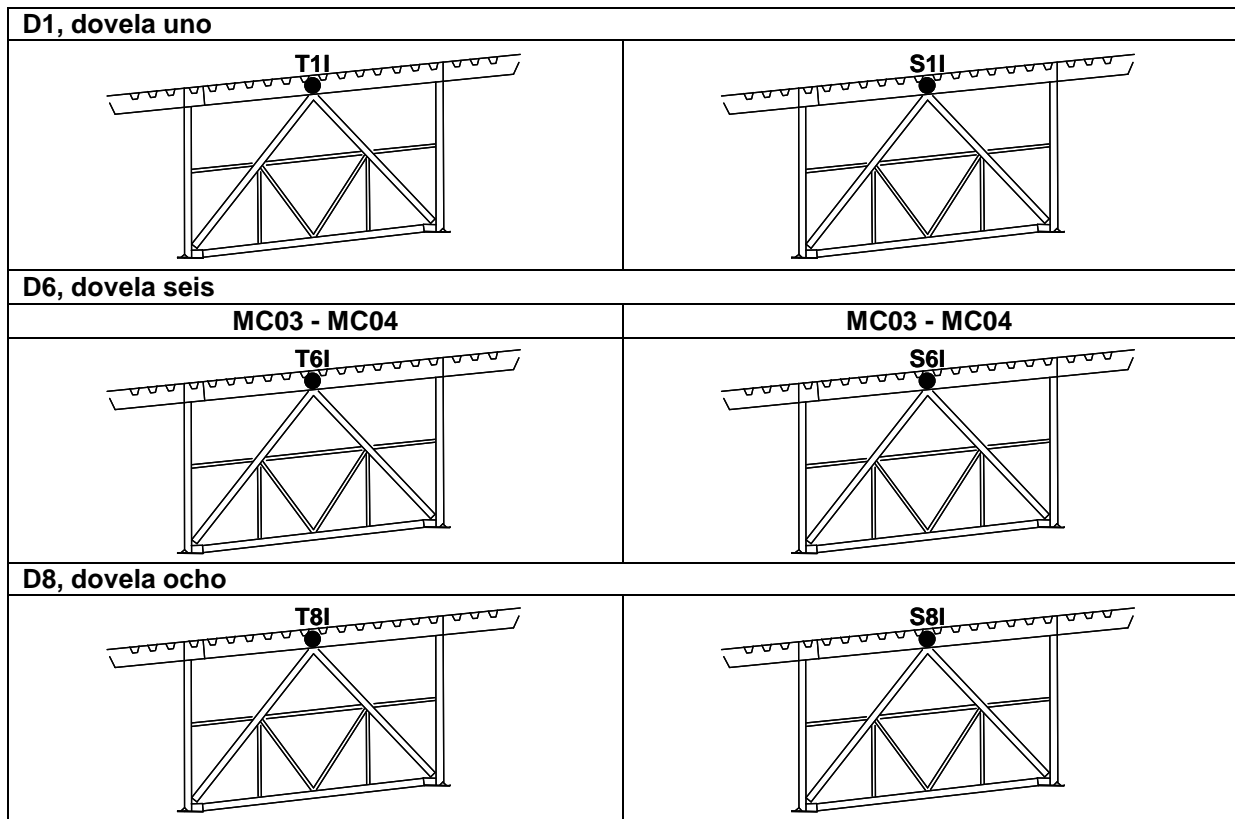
Distribución de los inclinómetros bidireccionales dentro de la superestructura del puente San Cristóbal
